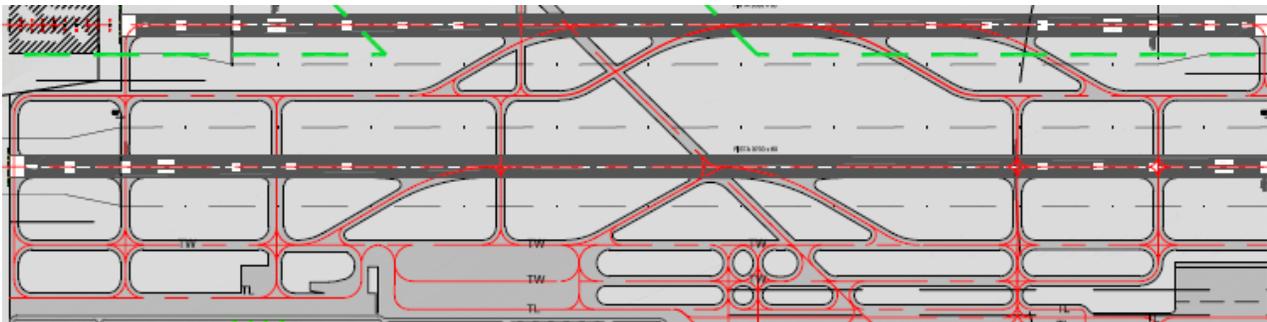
Calles de rodaje actuales y proyectadas en el Plan Maestro actual.
